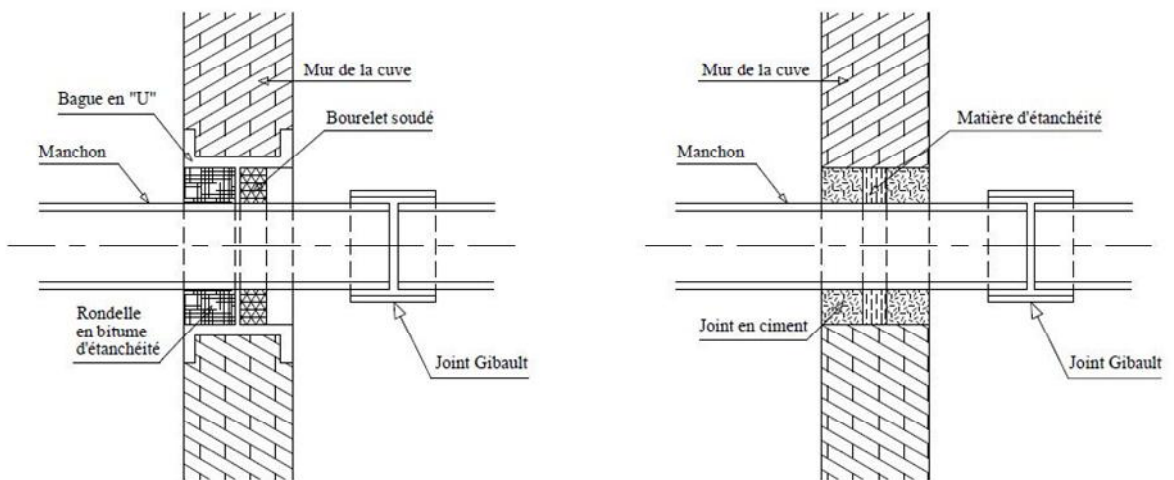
Traversée des conduites (manchon à bout lisse)
